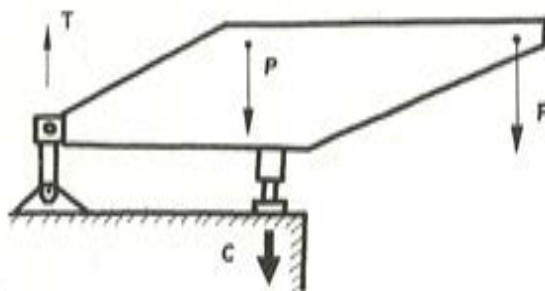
Apoyo y amarre vigas (fase hormigonado).
